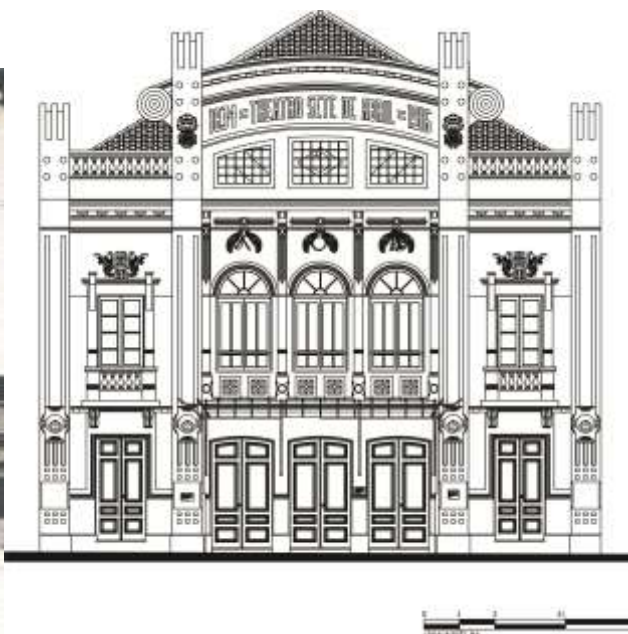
Fachada de 1916. Pelotas, RS. Fonte: CARRICONDE, 1922. s.p. Figura 24 – Fachada de 1916. AutoCAD. Fonte: SECULT, 2013.
